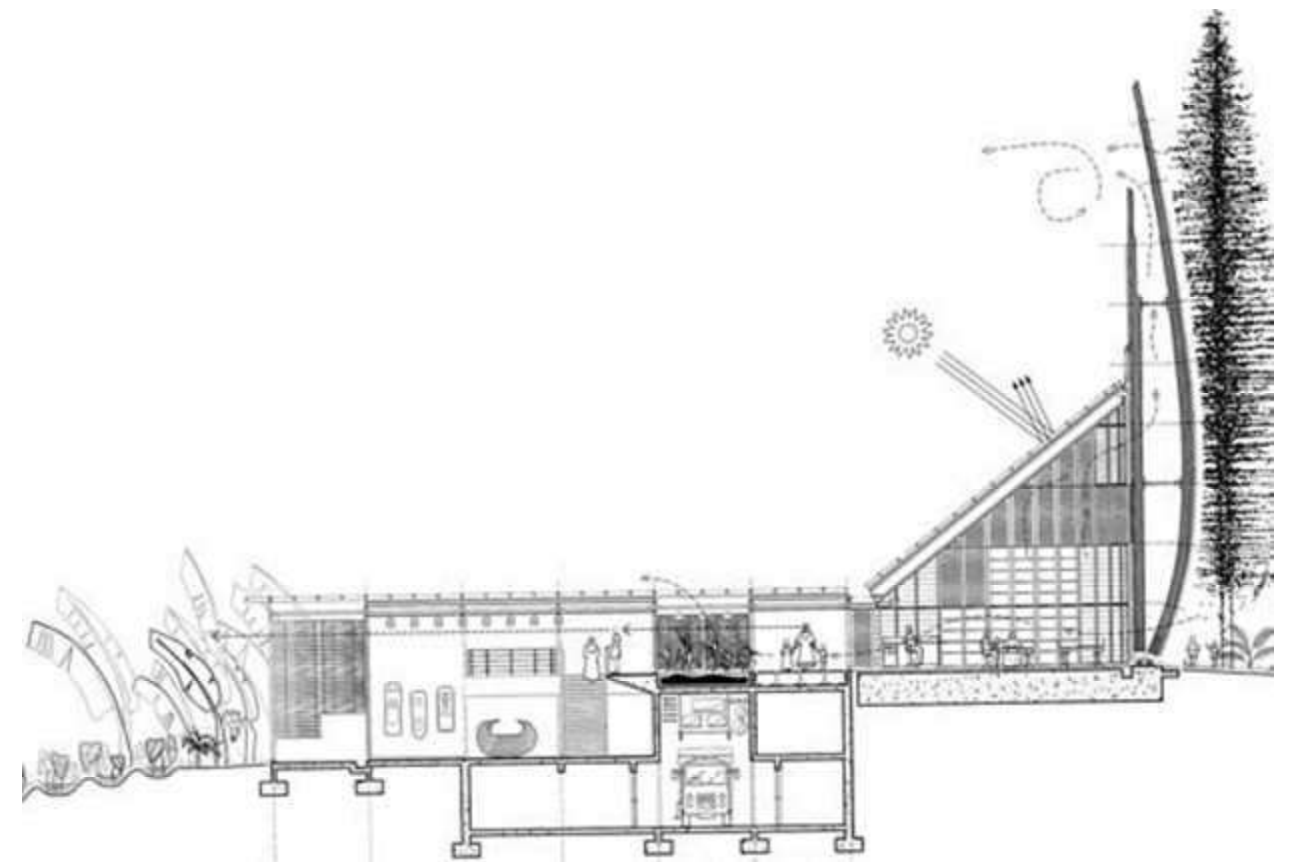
Corte transversal. Se observan los sistemas constructivos utilizados. Archdaily (s.f.).
